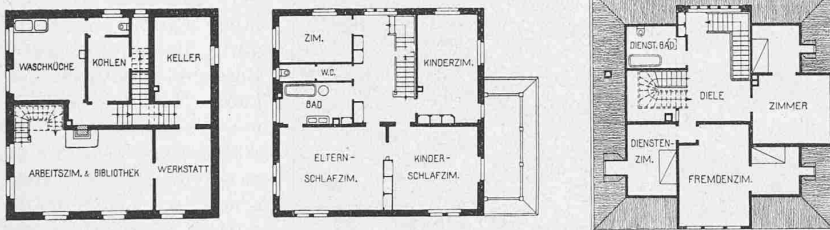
bis 4. Unter-, Ober- und Dachgeschoss. — Masstab 1 : 400.
